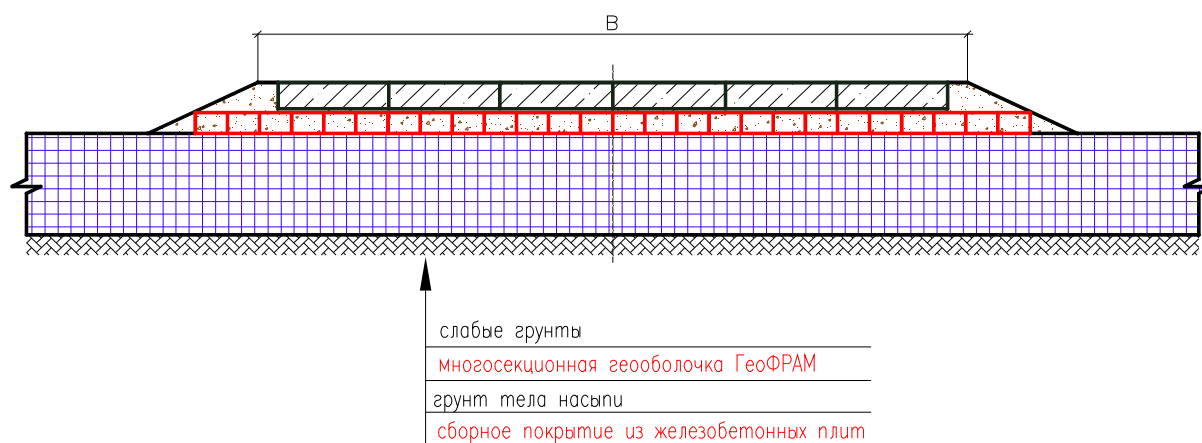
Поперечный профиль и конструкция вертолетной площадки с покрытием из железобетонных плит
